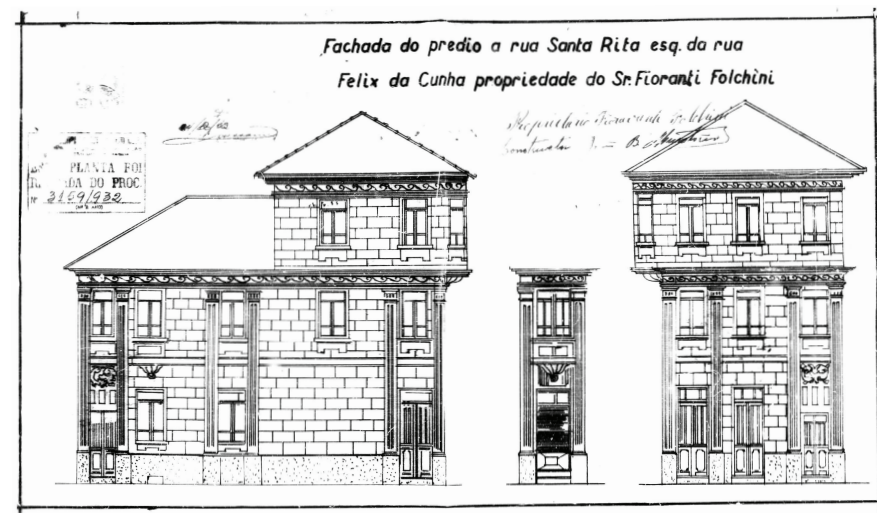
e 13 - Projeto de aumento do Armazém Avante (Arquivo Municipal de Porto Alegre)
